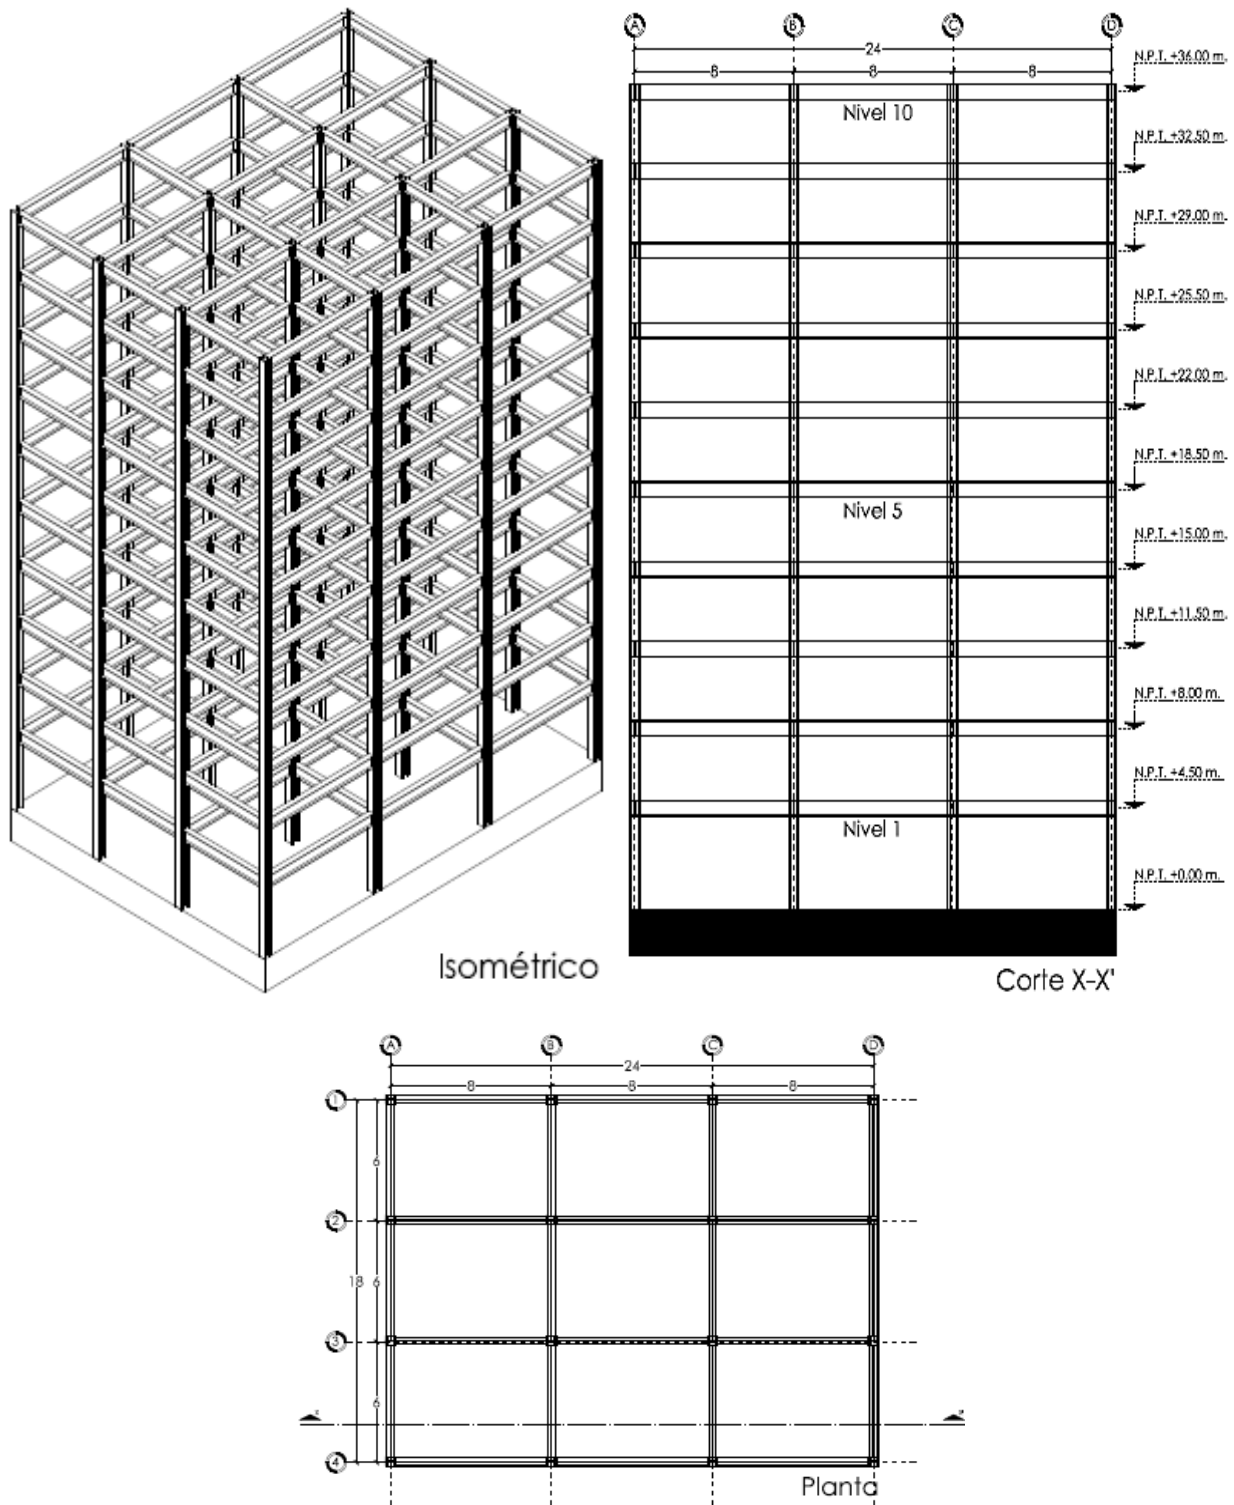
Marco de 10 niveles vista en (isométrico, corte y planta tipo).
